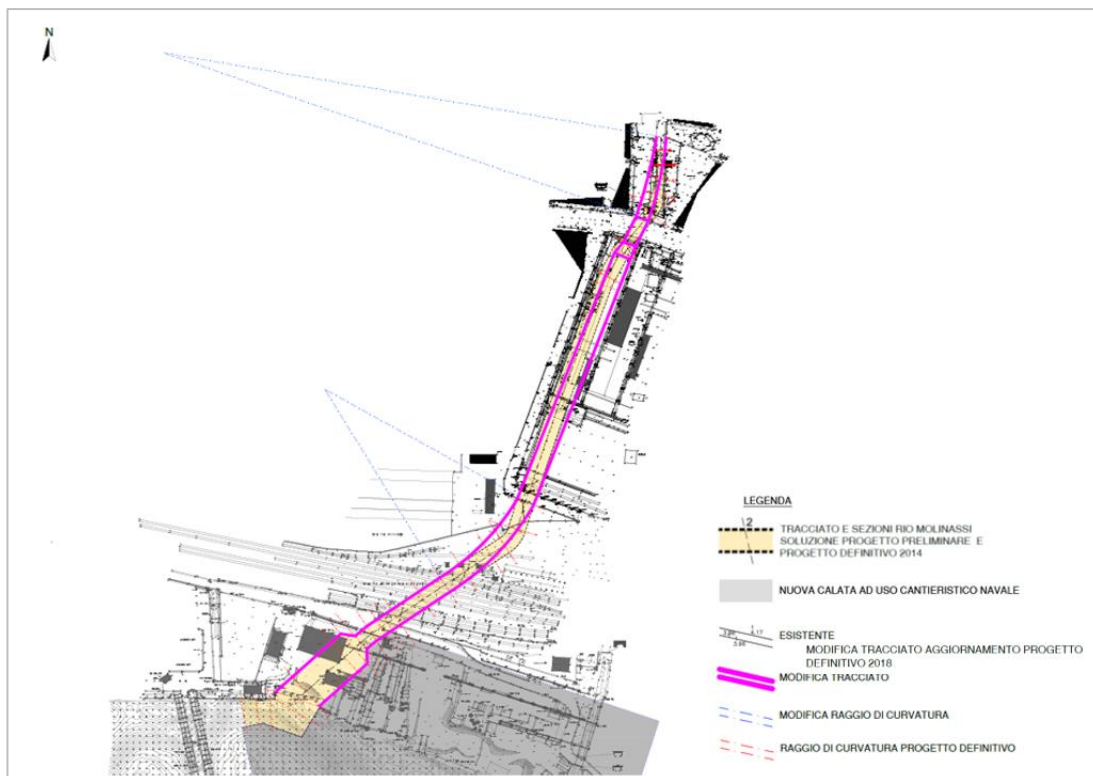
Planimetria progetto definitivo in corrispondenza dell'attraversamento del parco ferroviario
